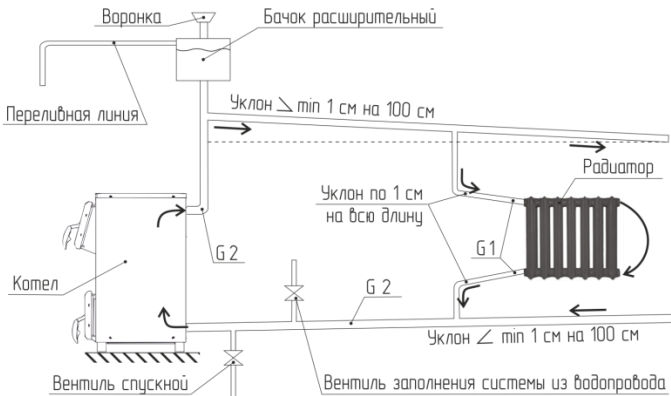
Схема подсоединения котла к отопительной системе и водопроводу
